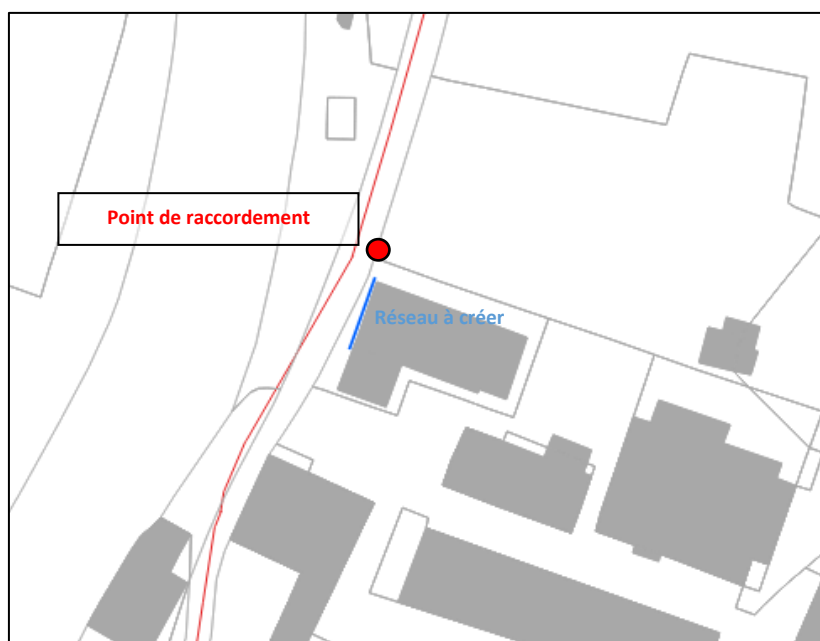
Raccordement EP à mettre en œuvre pour déconnecter la toiture
